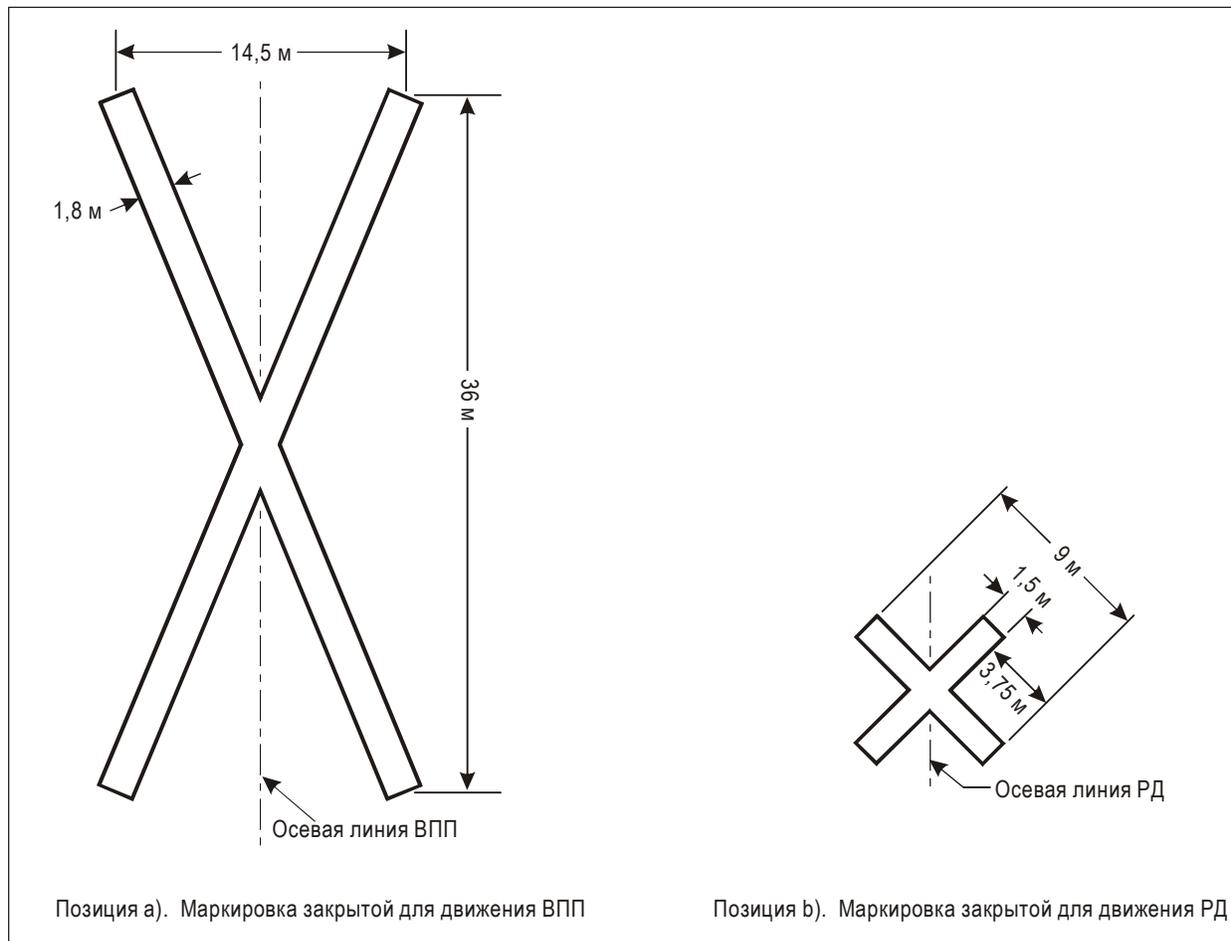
Маркировка закрытых для движения ВПП и РД
